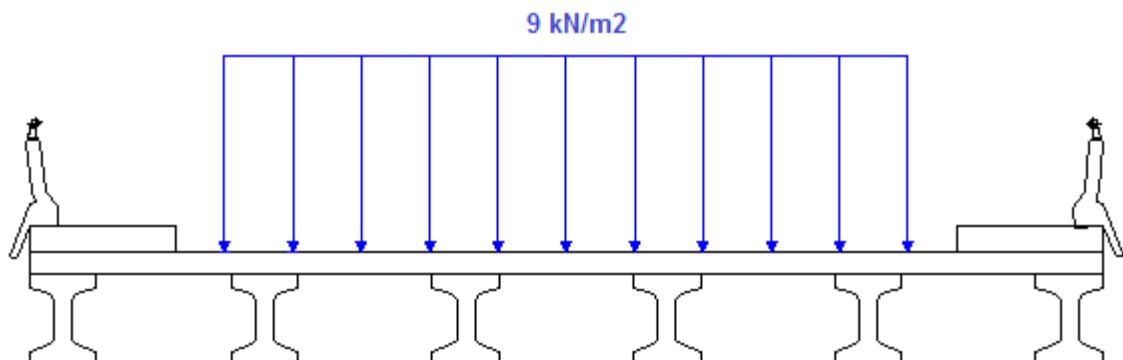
Representación de la sobrecarga de uso en vigas centrales.
